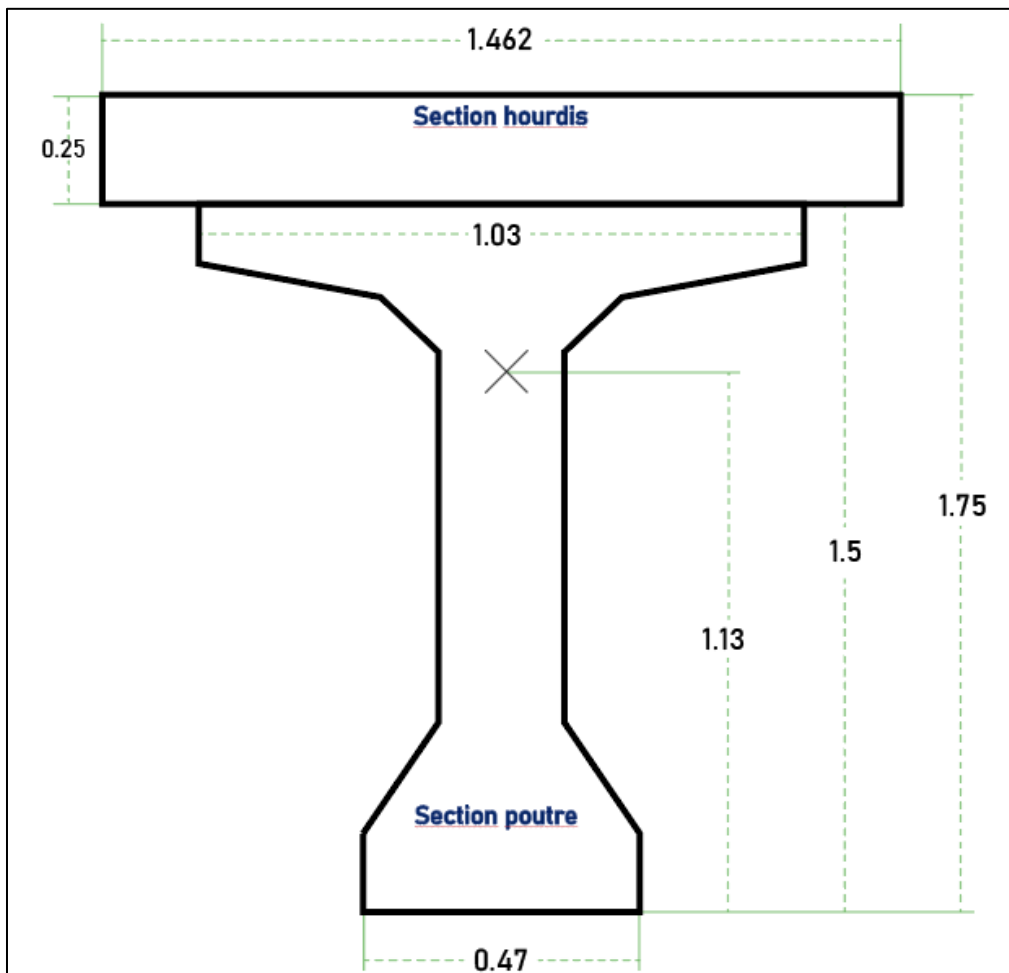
les dimensions de la section de la poutre + hourdis à mi-travée
